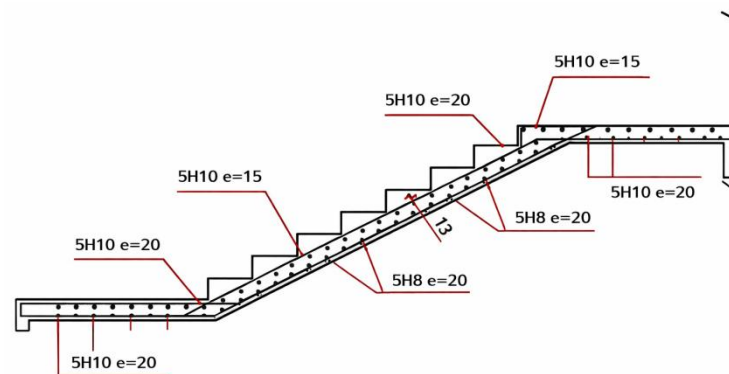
Ferrailage du volée 1 et 2 de l'escalier
